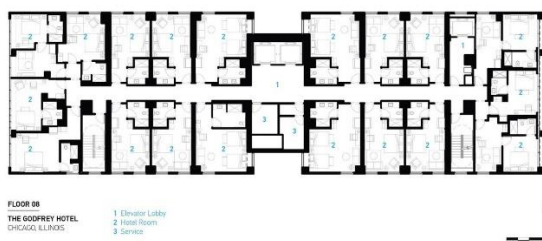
Planta baixa 4º pavimento Hotel Godfrey
